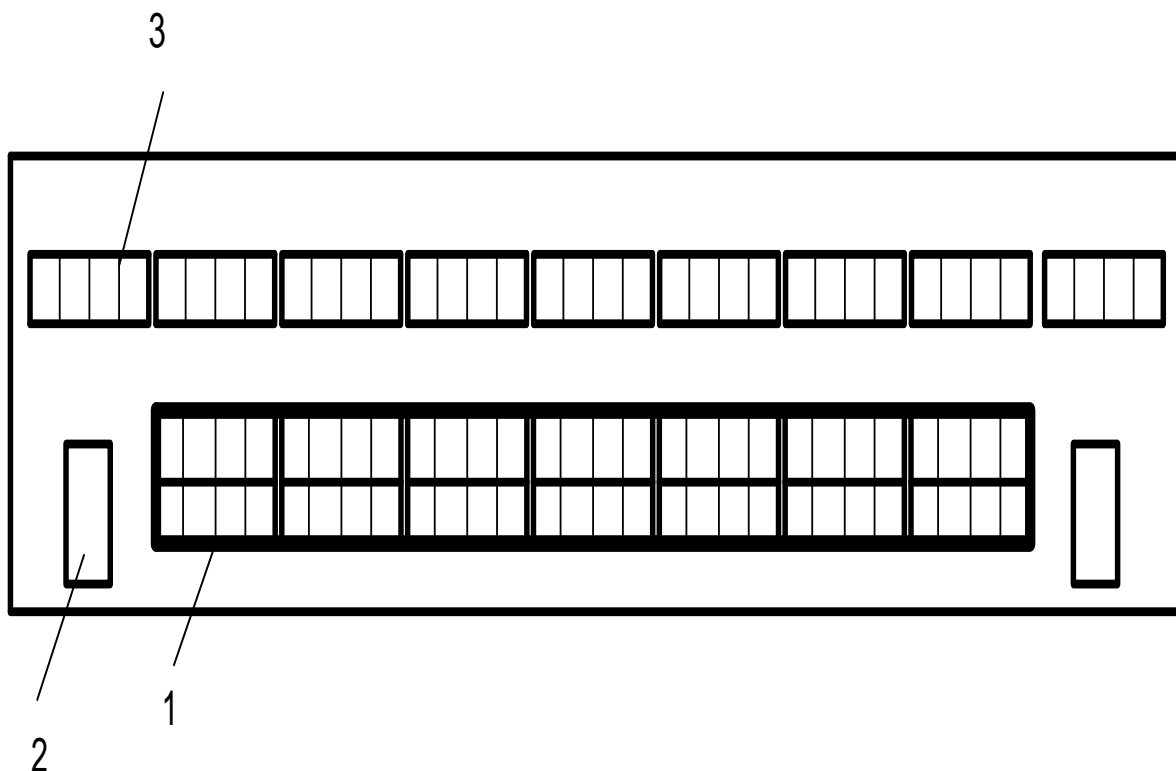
Фасад насосного зала НПС-3, с указанием оконных проемов, предназначенных для размещения ЛСК
